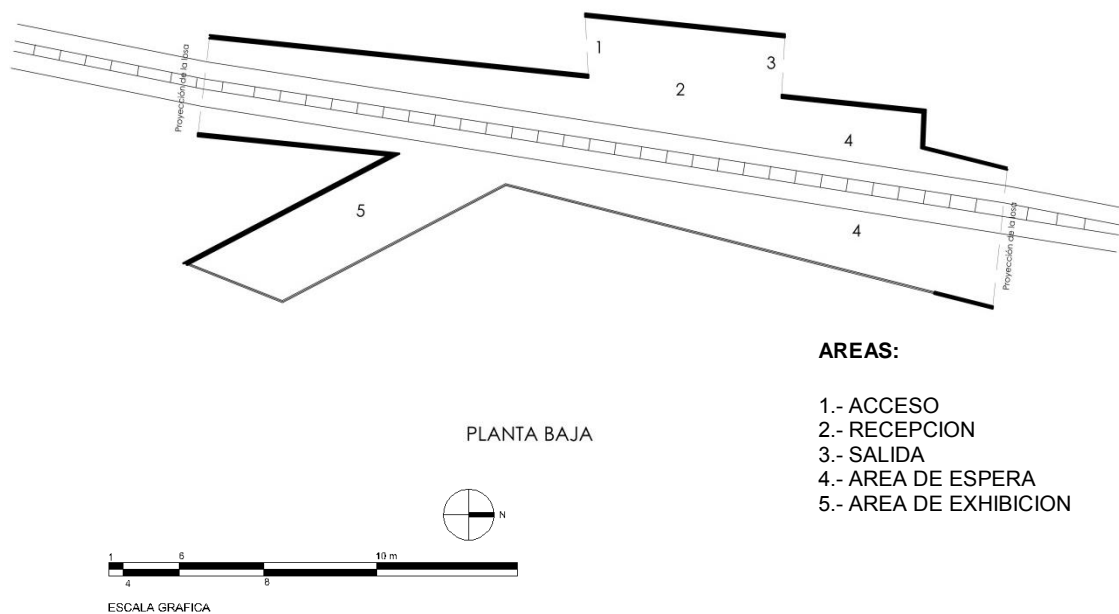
Plantas arquitectónicas de restaurant-souvenirs. Autoría: Propia
